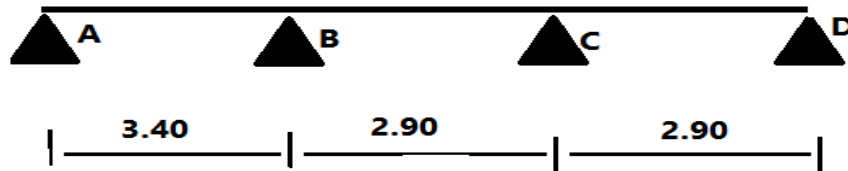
Schéma du 2^{ème} type de poutrelle.
